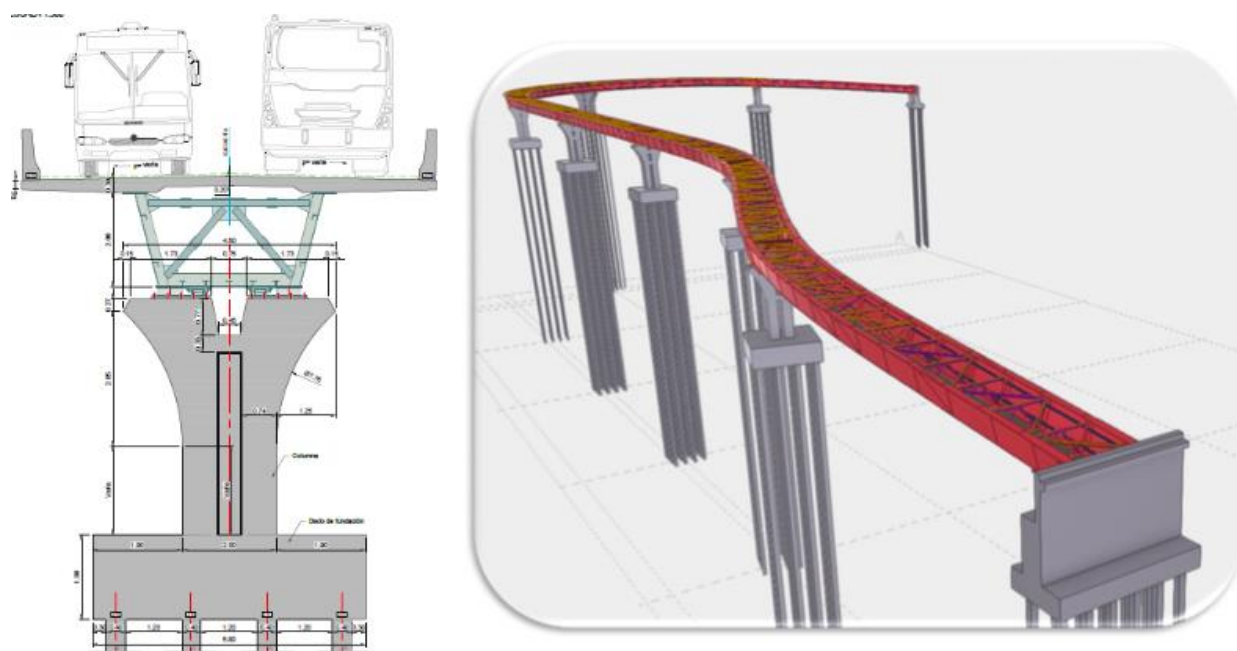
Modelo 3d Puente conectante, Construcción del autor.
